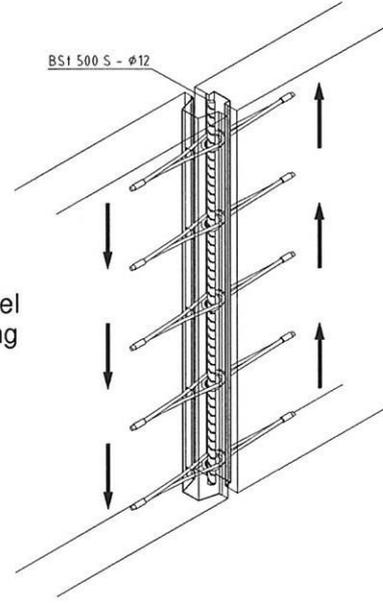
Beanspruchung parallel zur Fugenlängsrichtung
